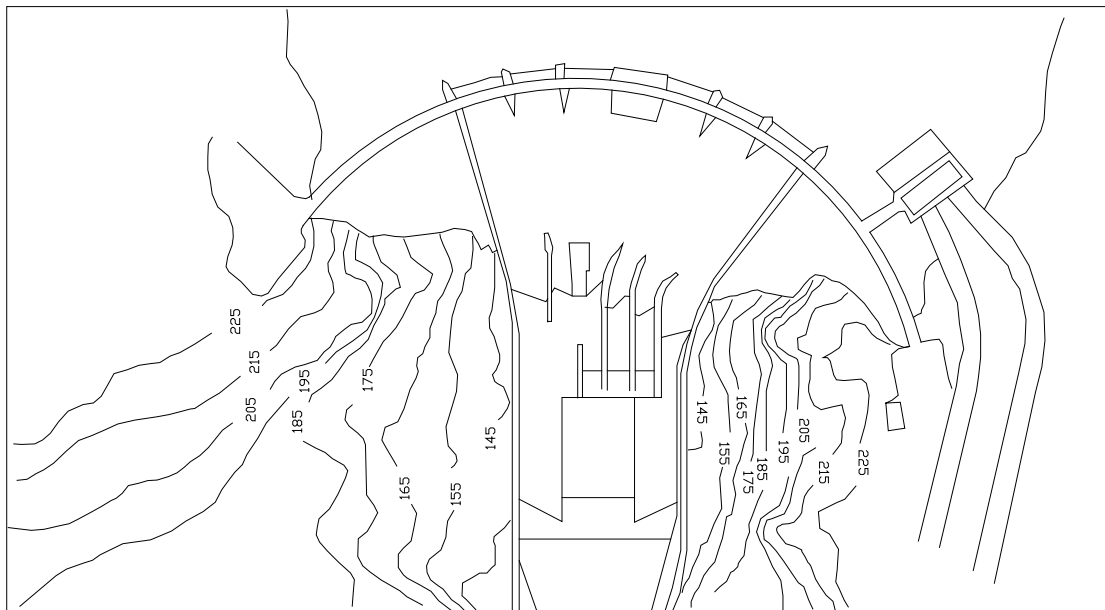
Planta de la estructura de la presa San Esteban. Escala 1:2600.
